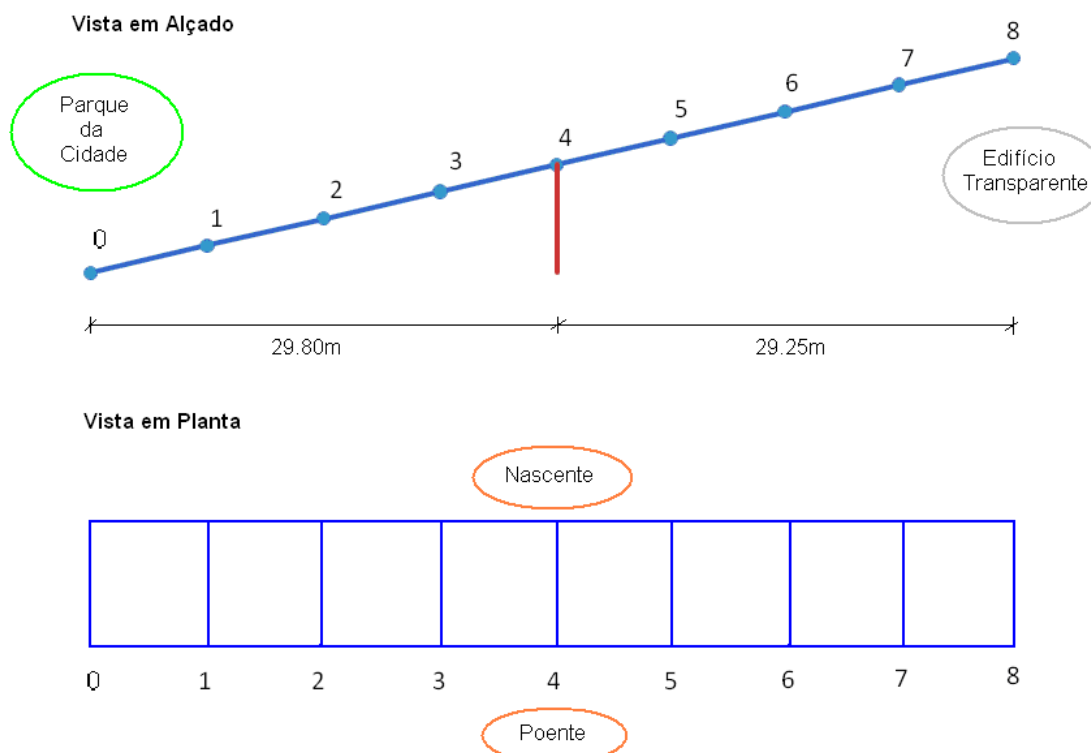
Vista em alçado e em planta dos pontos escolhidos para a realização do ensaio In-Situ.
